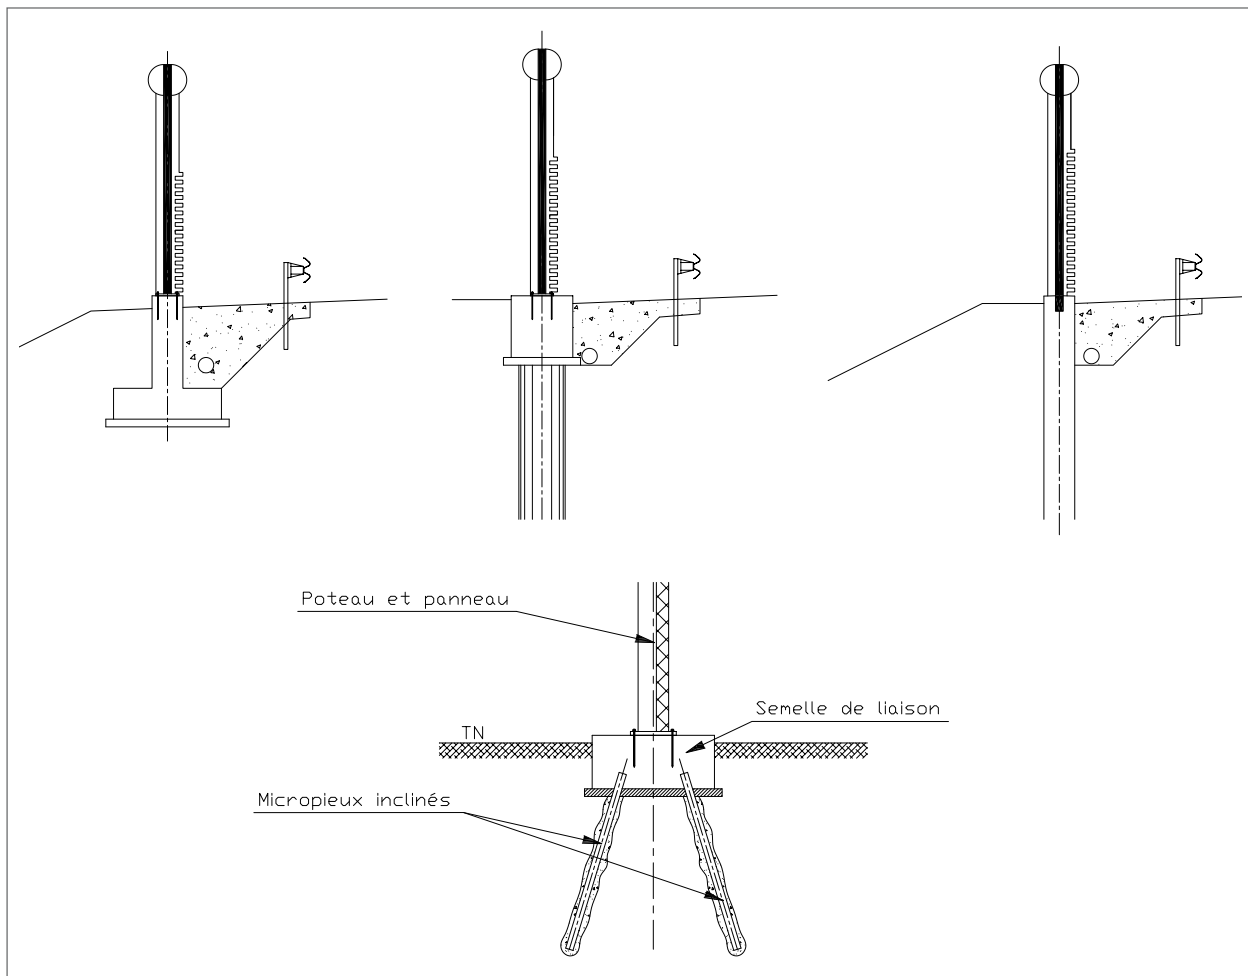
Coupes types de murs - Fondations superficielles et profondes
